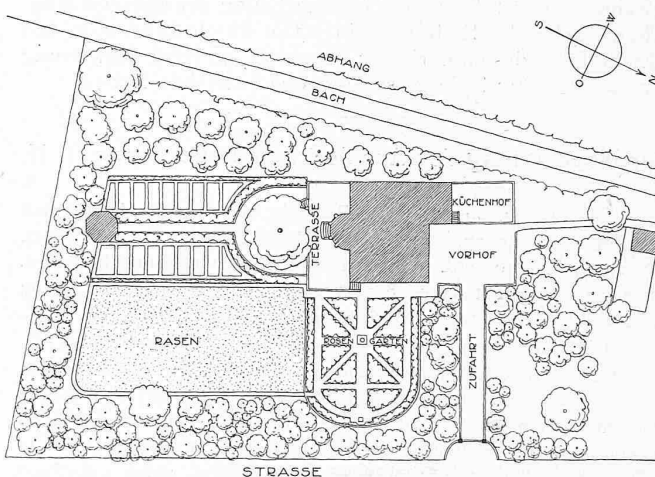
bis 16. Haus Pfefferkorn. Lageplan 1:1000, Grundrisse 1:400.
